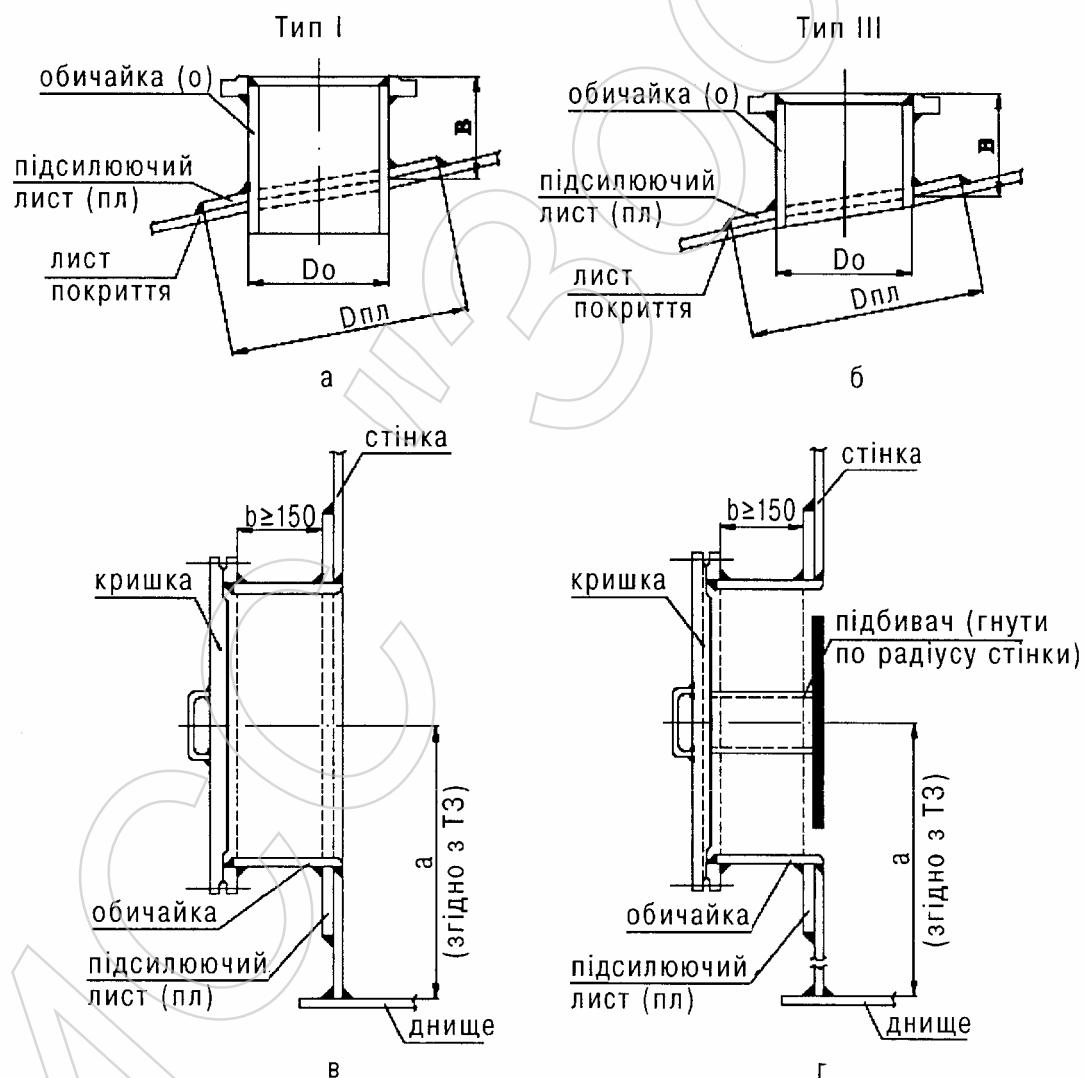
Схеми розташування патрубків на покритті (а, б); люків-лазів для виходу на днище (в); на ponton або плаваюче покриття (г)
